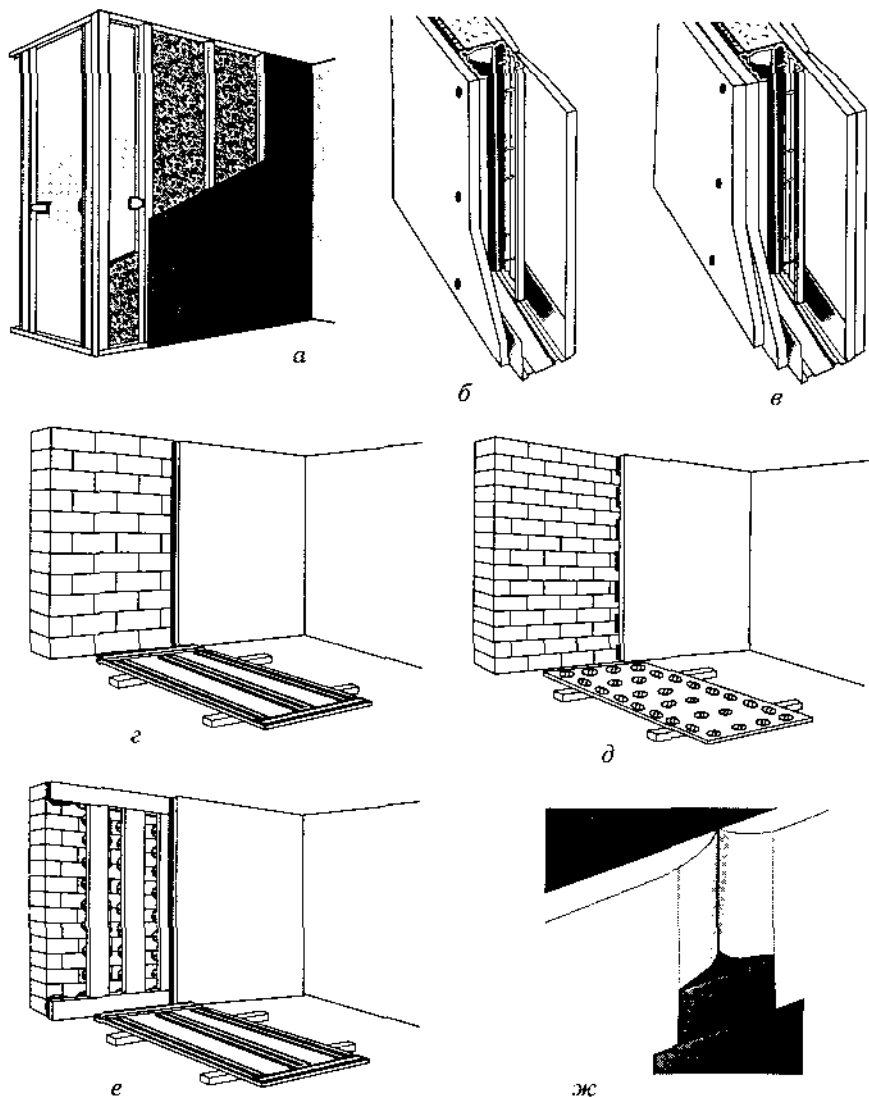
Облицовка перегородок и стен листами ГКЛ:
